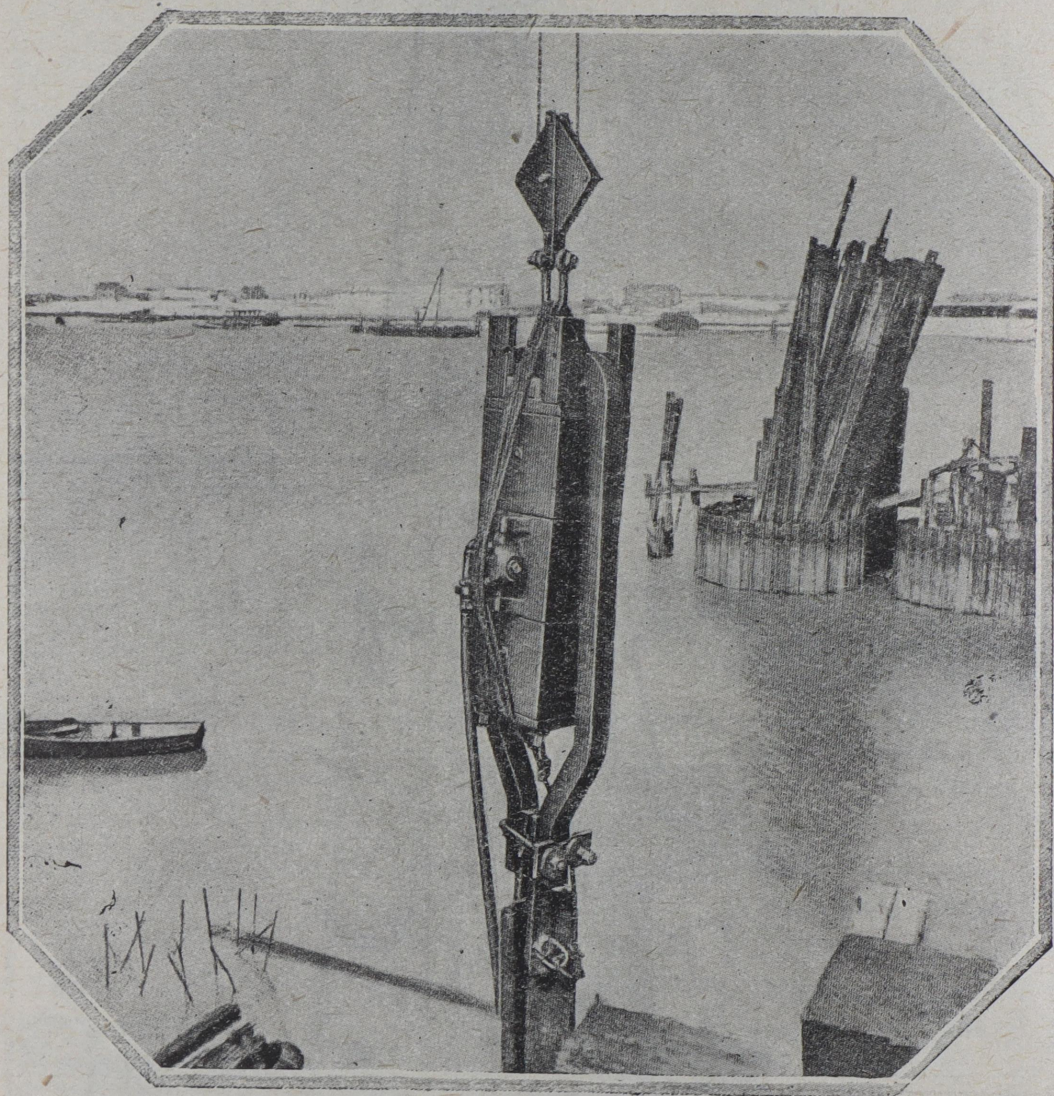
изображает работу свайного молота, установленного в станине обыкновенного копра для забивки двадцатиметровых бетонных свай под фундамент многоэтажной фабрики.
